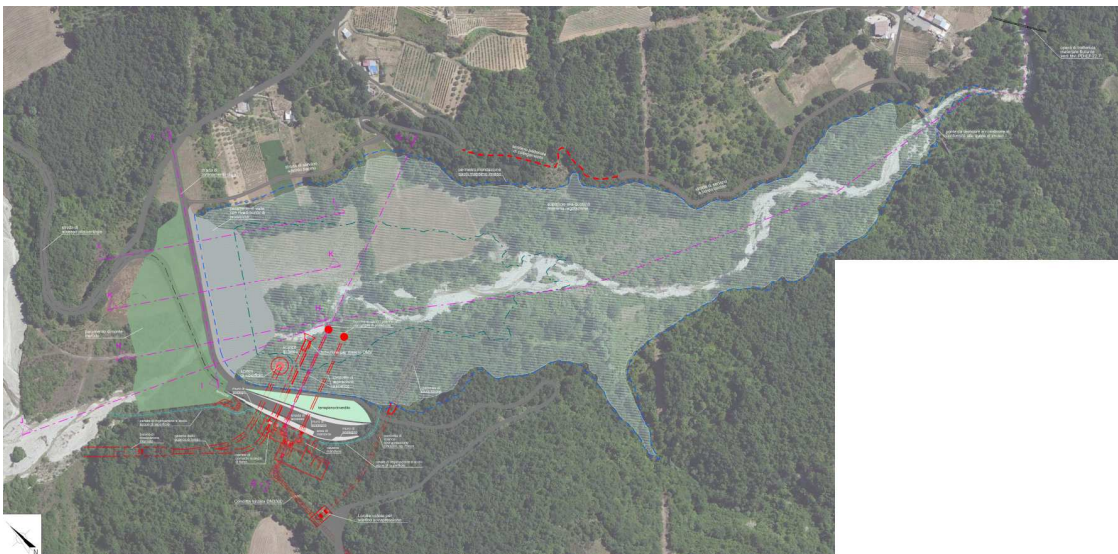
Planimetria di progetto dell'invaso di valle (PD-EP.19.1).
